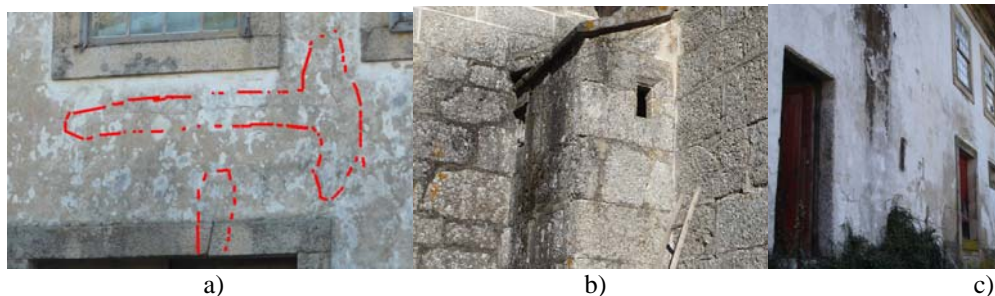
a) Fissuras horizontais e verticais na fachada – Norte do compartimento 2; b) Humidades e vegetação parasitária – fachada, este do compartimento 5; c) Humidades e vegetação parasitária – fachada NW do compartimento 9
